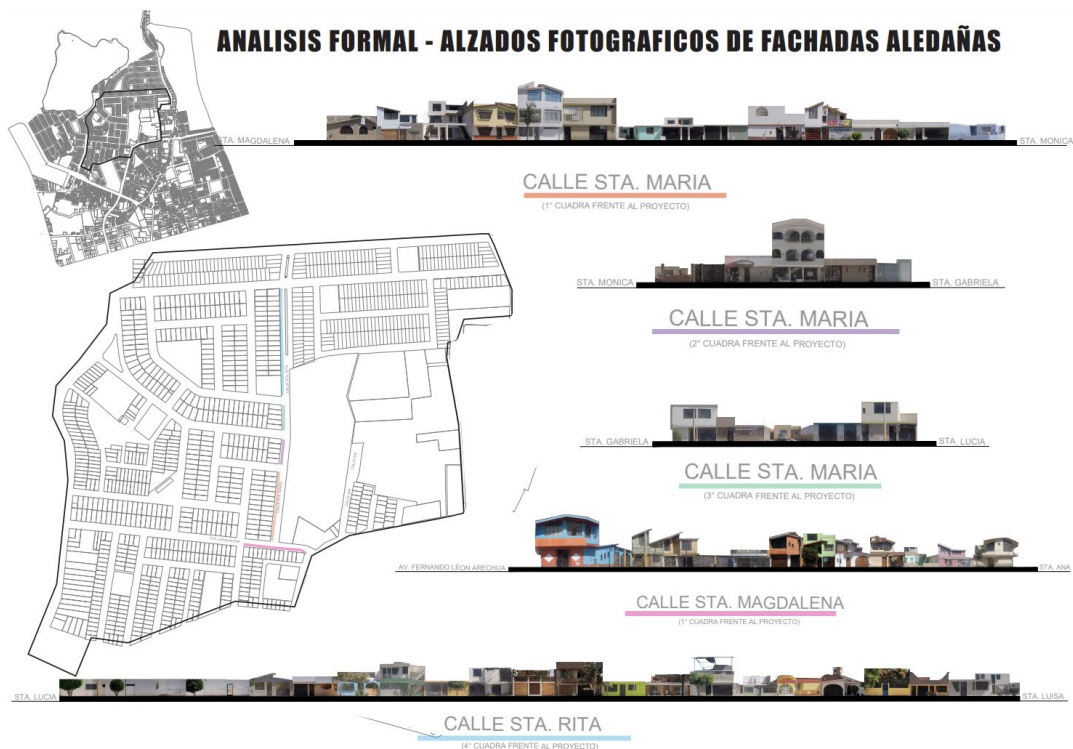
Análisis formal y alzados fotográficos de fachadas aledañas al complejo deportivo. Elaboración: Propia.
